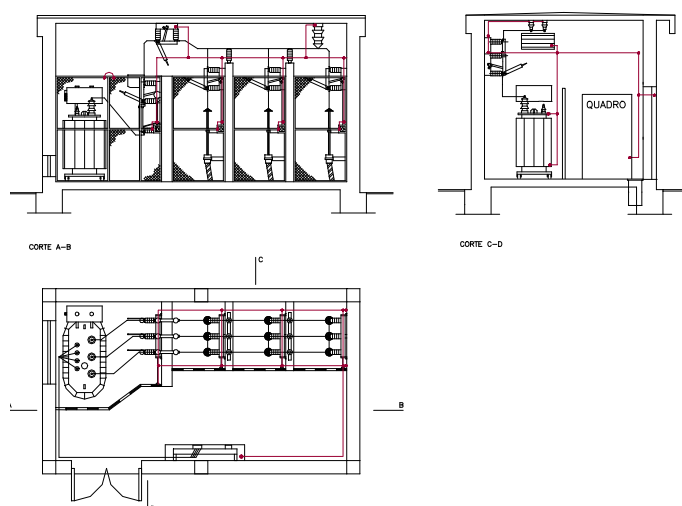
PT tipo CB • Ligação das partes metálicas à terra de protecção
